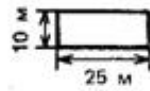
План прямоугольного котлована (10 и 25 – размеры дна котлована в плане)
